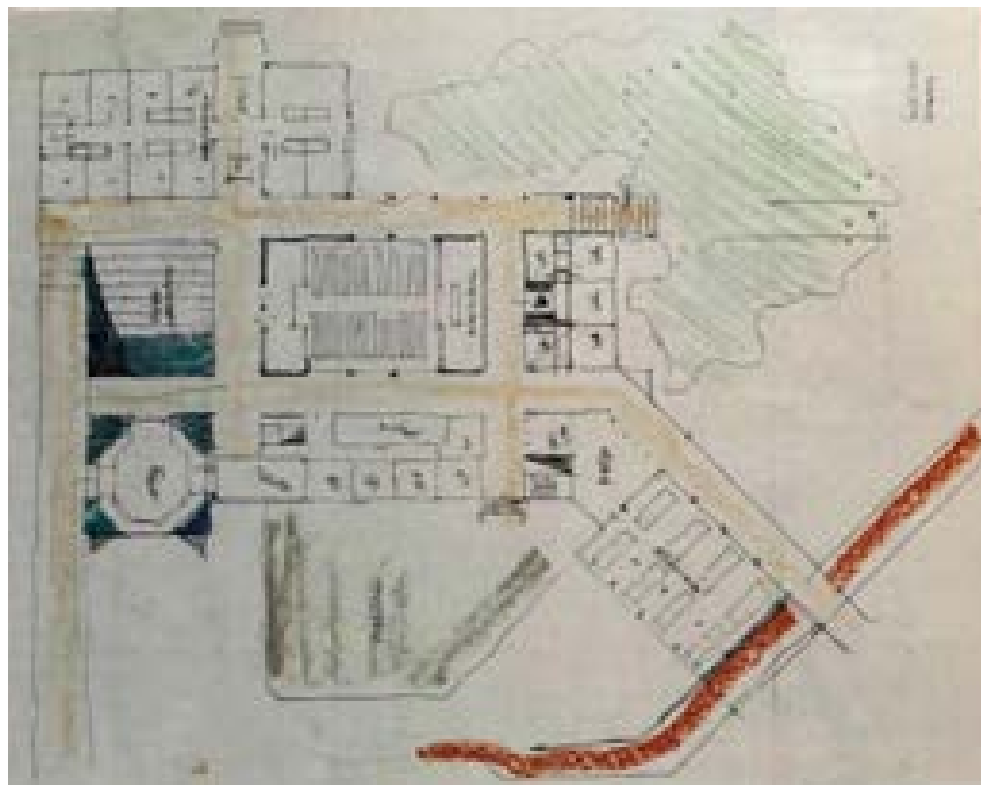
Planimetria maglia strutturale +1,00, stato futuro - 1989 (AABS-64_443)
